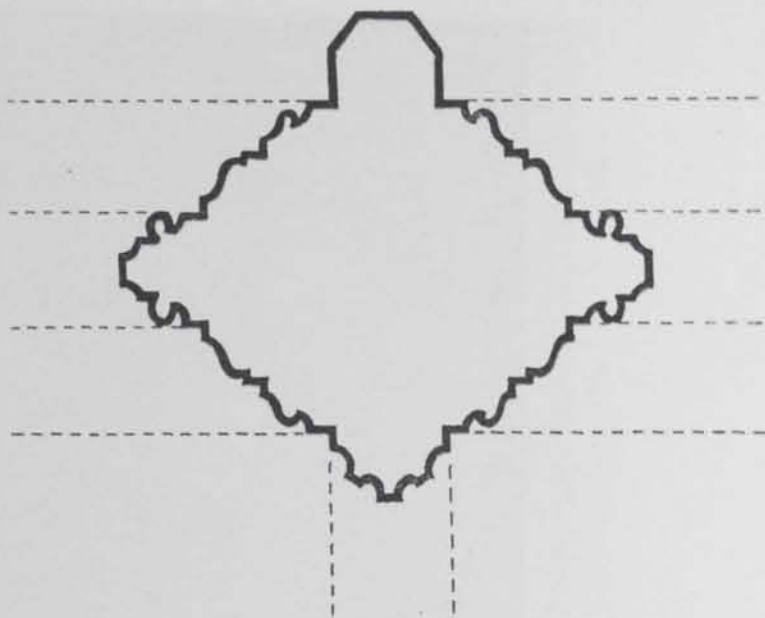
Santes Creus. Secció del pilar de la galeria Est
